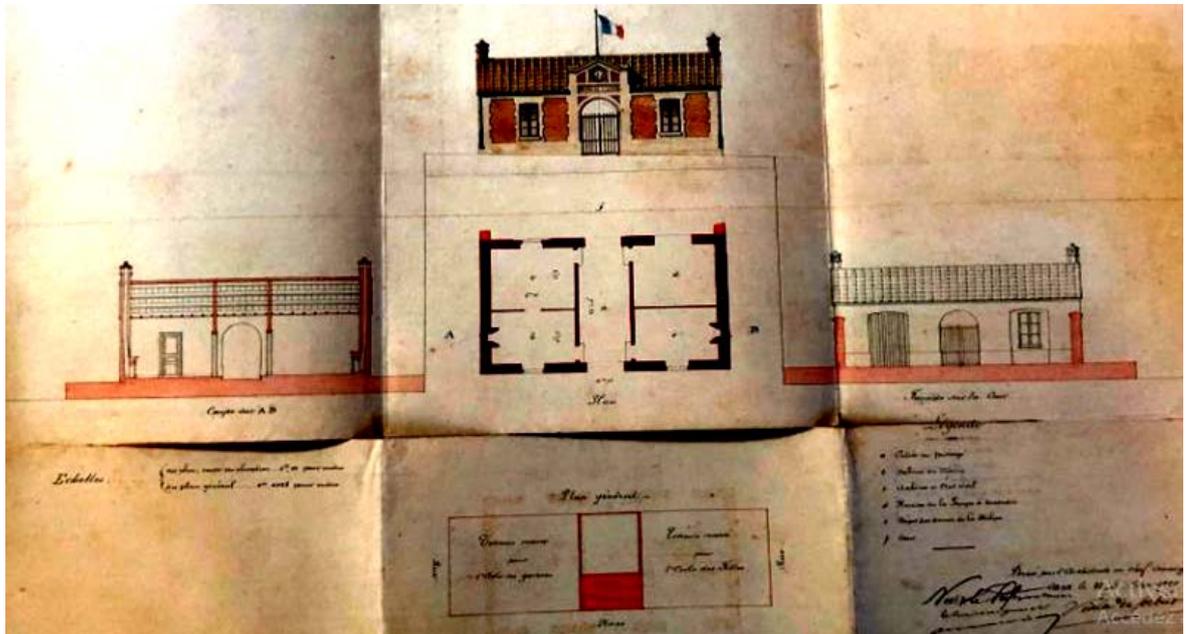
Plan d'ensemble, plan du RDC, les différentes façades de la mairie de *Saint Louis* [85]
